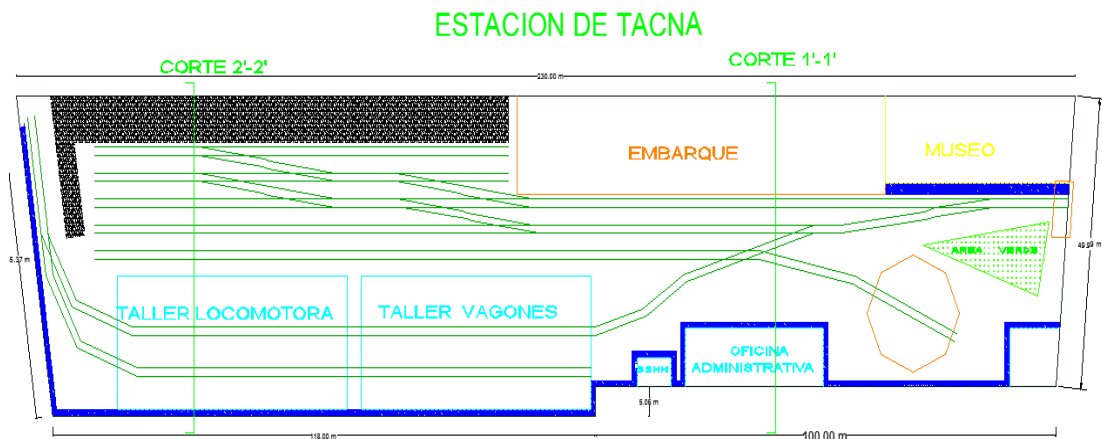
Planta de la Estación Tacna, fuente propia
